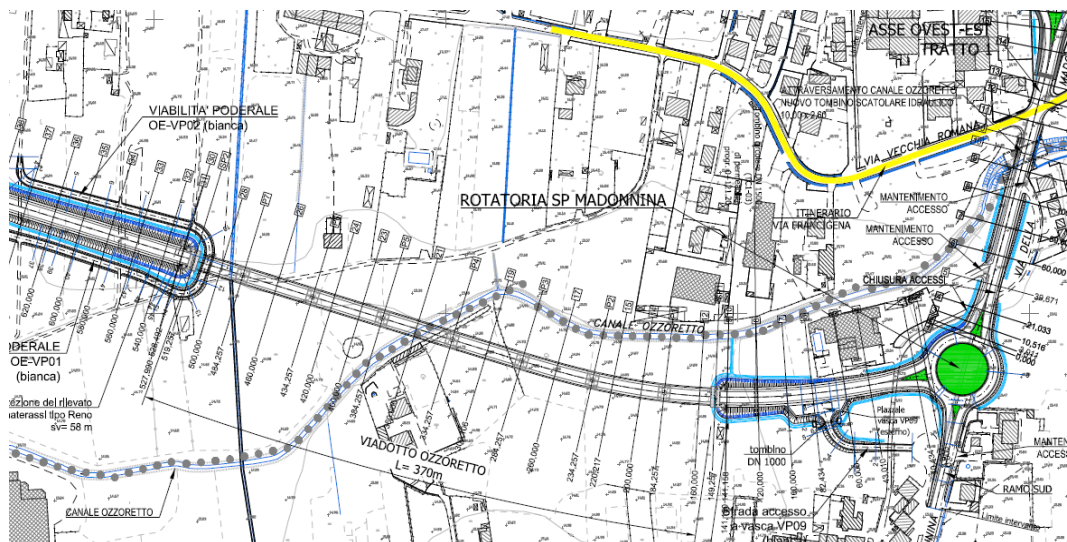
Viadotto Ozzoretto: stralcio planimetrico
